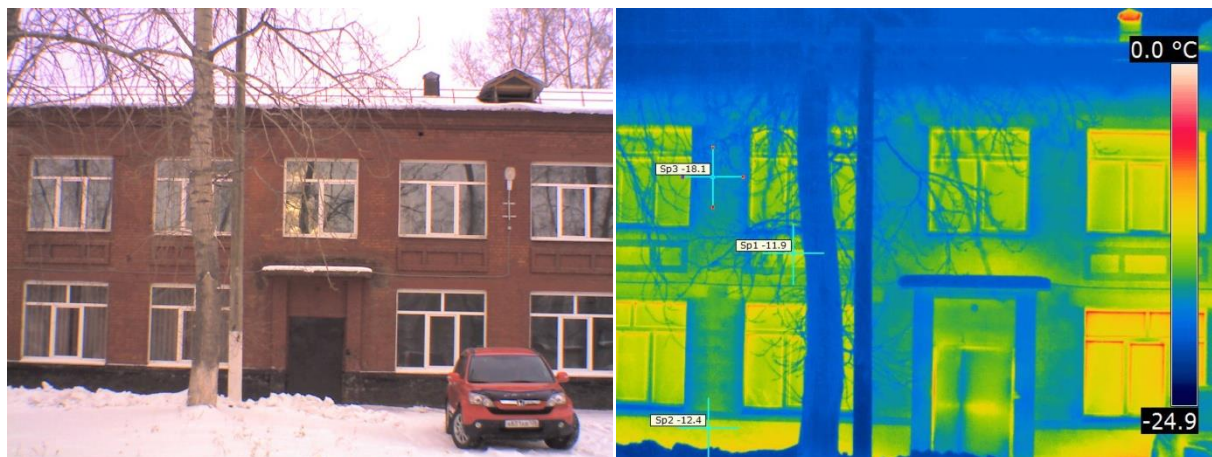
Лабораторный корпус, северо-восточная сторона, середина 1
